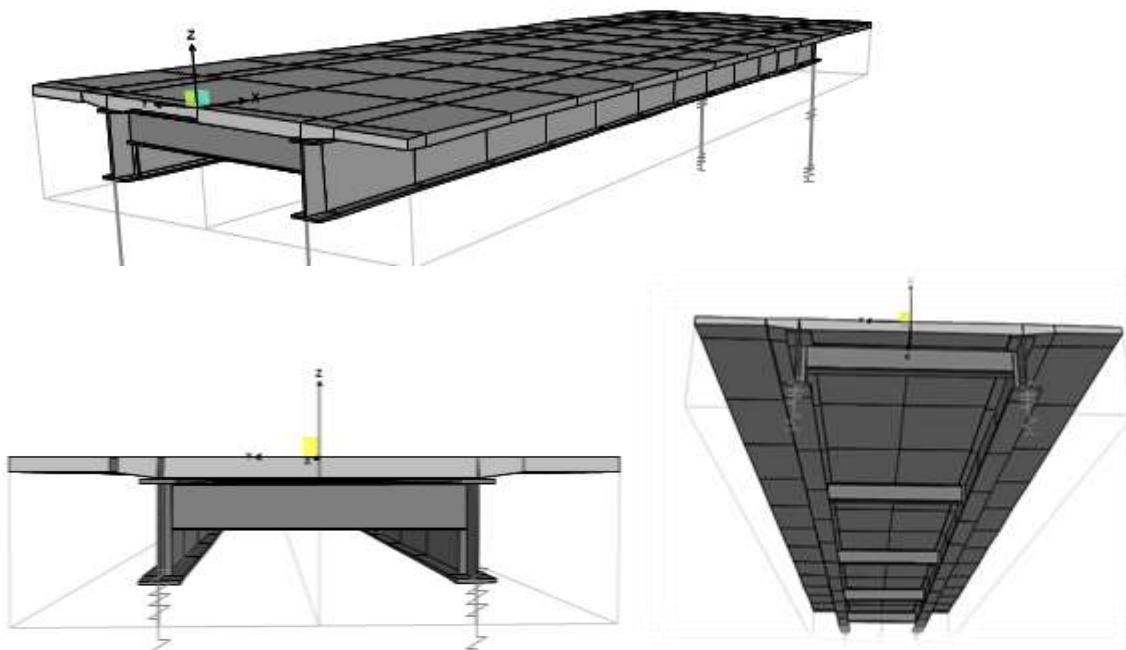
Modélisation du tablier mixte bipoutres sur CSIBRIDGE.
